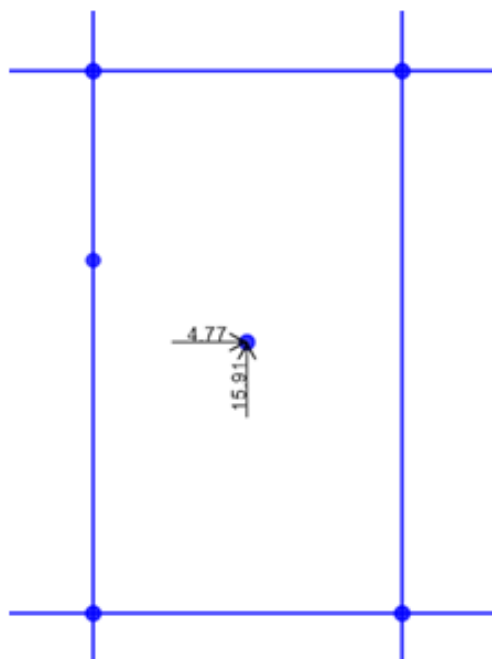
Vista en planta de la edificación y sus nodos de excentricidad accidental en planta.
